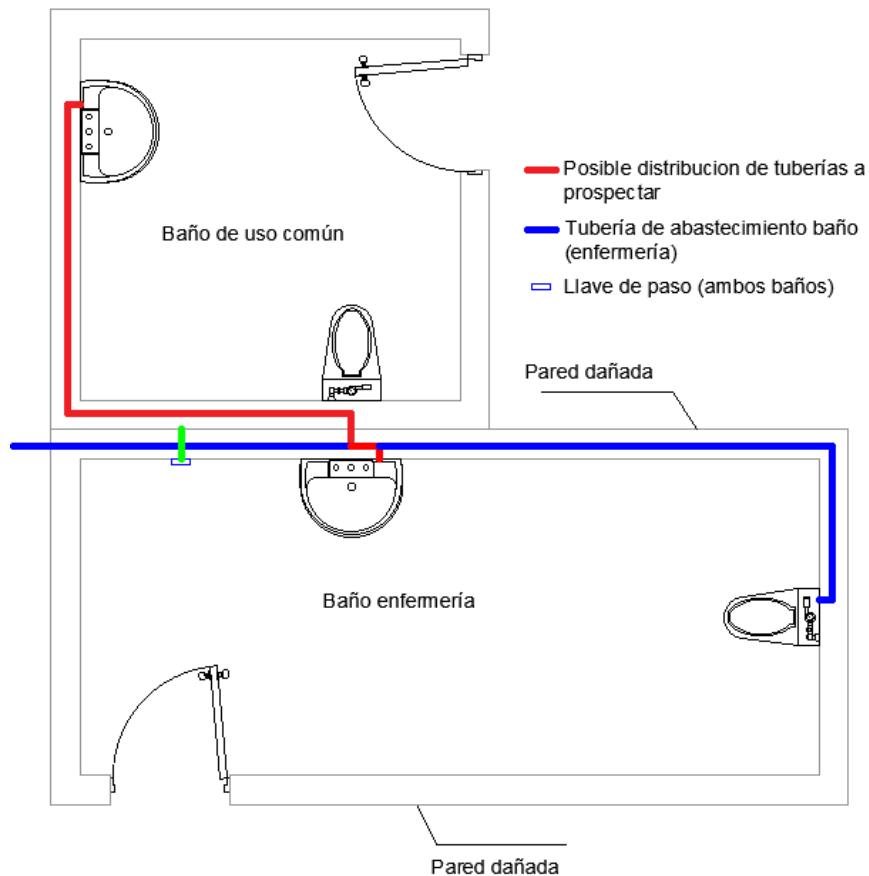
Esquema en planta de ramal elegido (Posible localización)
